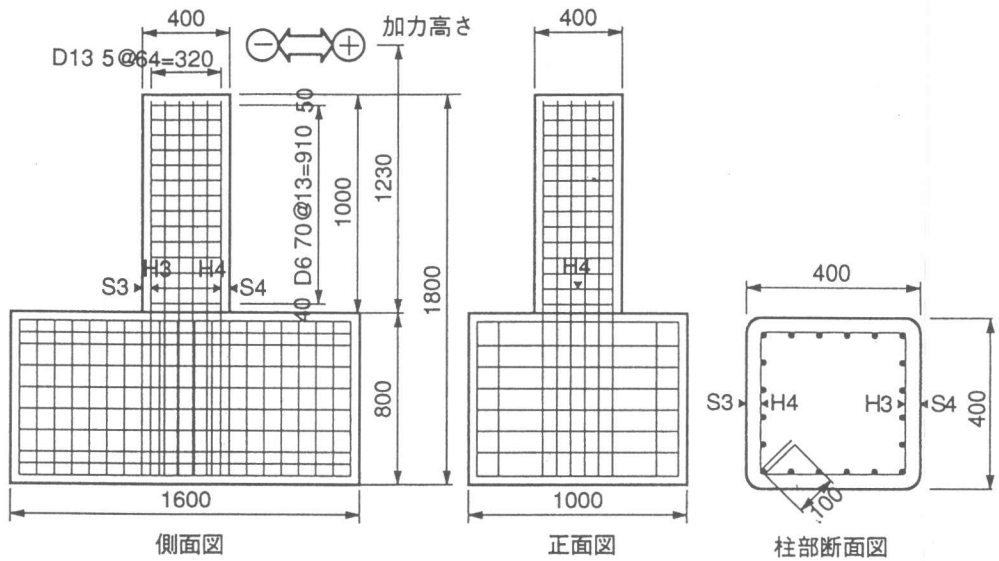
供試体寸法・配筋・ひずみゲージ貼付位置
